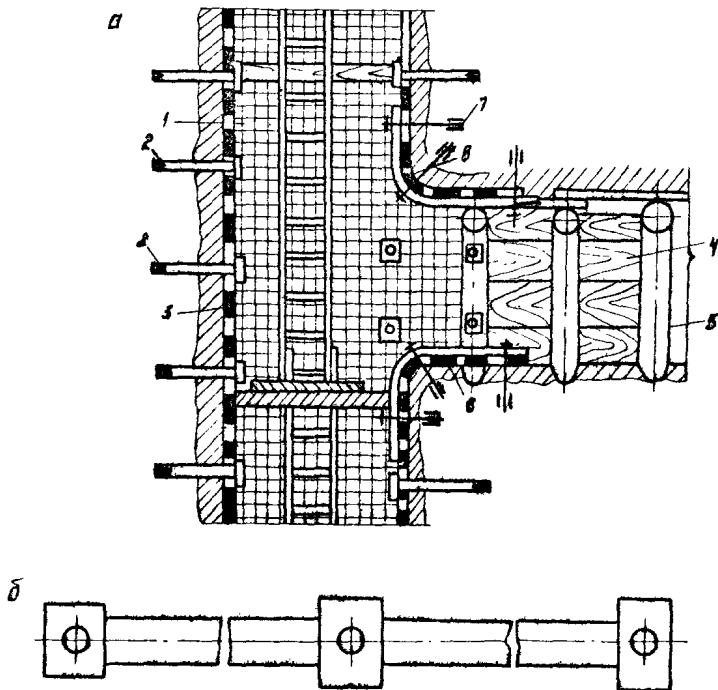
Схема крепления восстающей к горизонтальной с использованием гибких металлических подхватов (а), конструкция гибкого подката (б)
